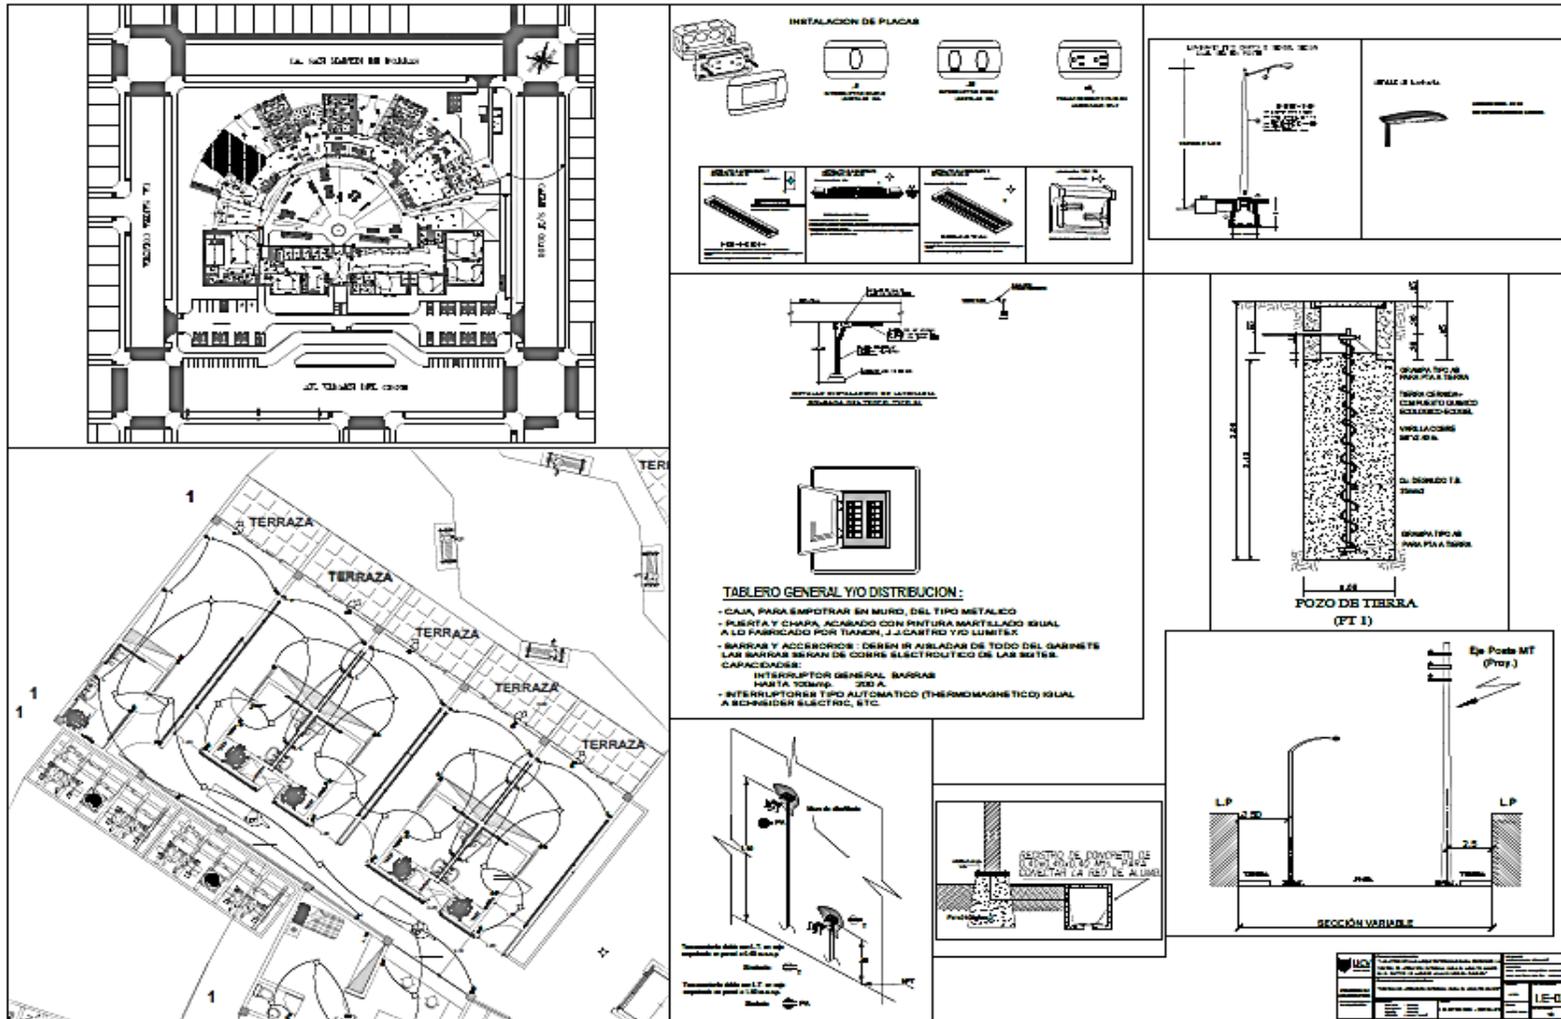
Plano de diseño e instalaciones eléctricas básicas (detalles)
